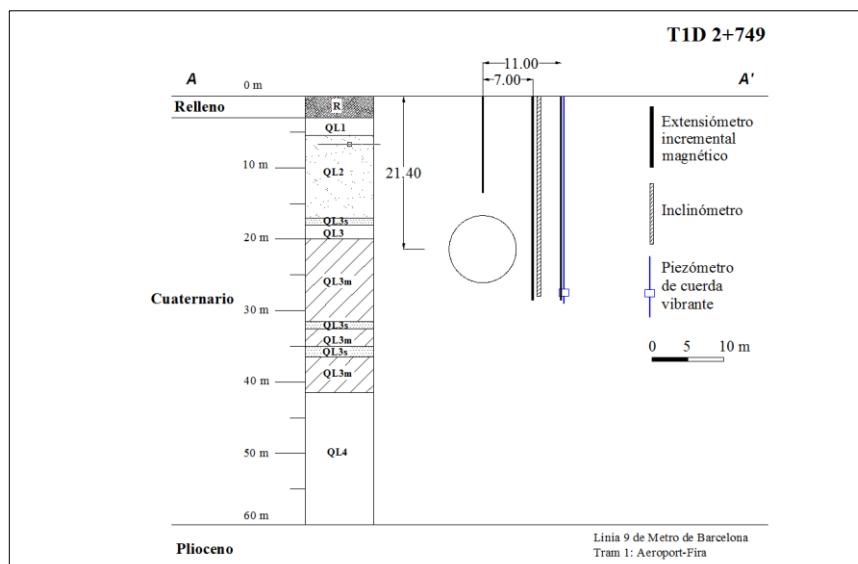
4. Perfil de la instrumentación instalada en la sección de control T1D PK 2+750
